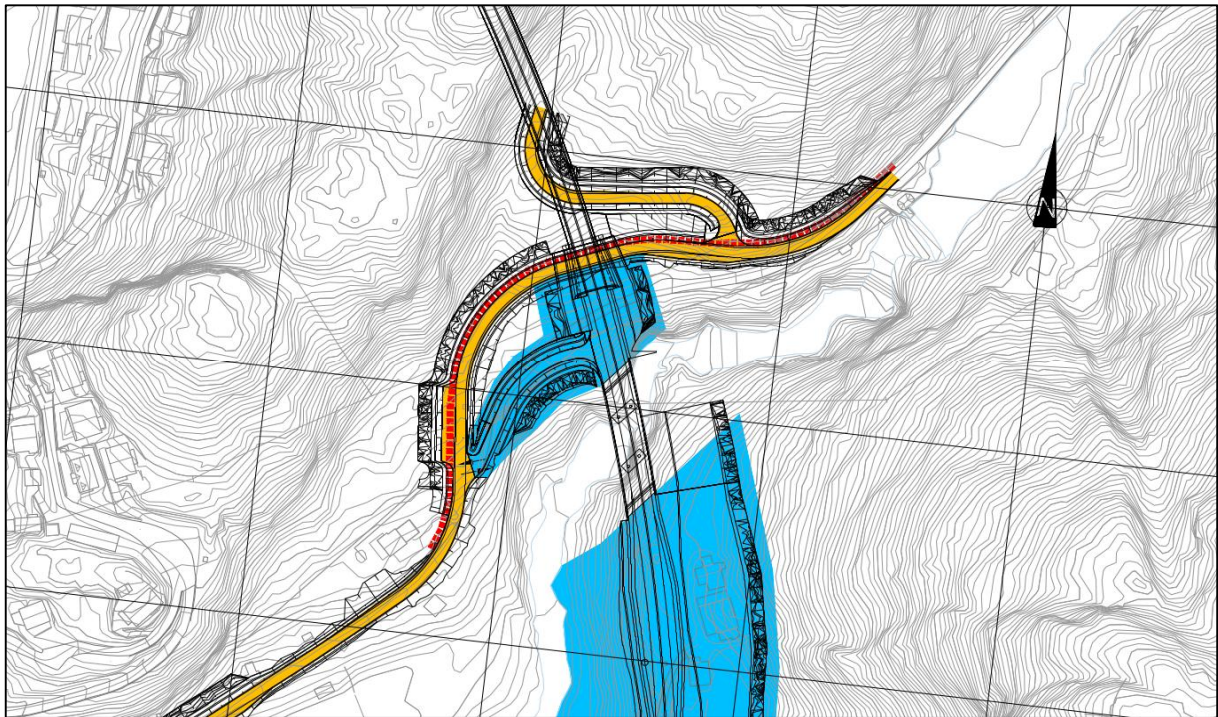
Utsnitt faseplan ved Brualeite. Utklipp fra faseplan, se UAS-01-Y-02202 [13].
